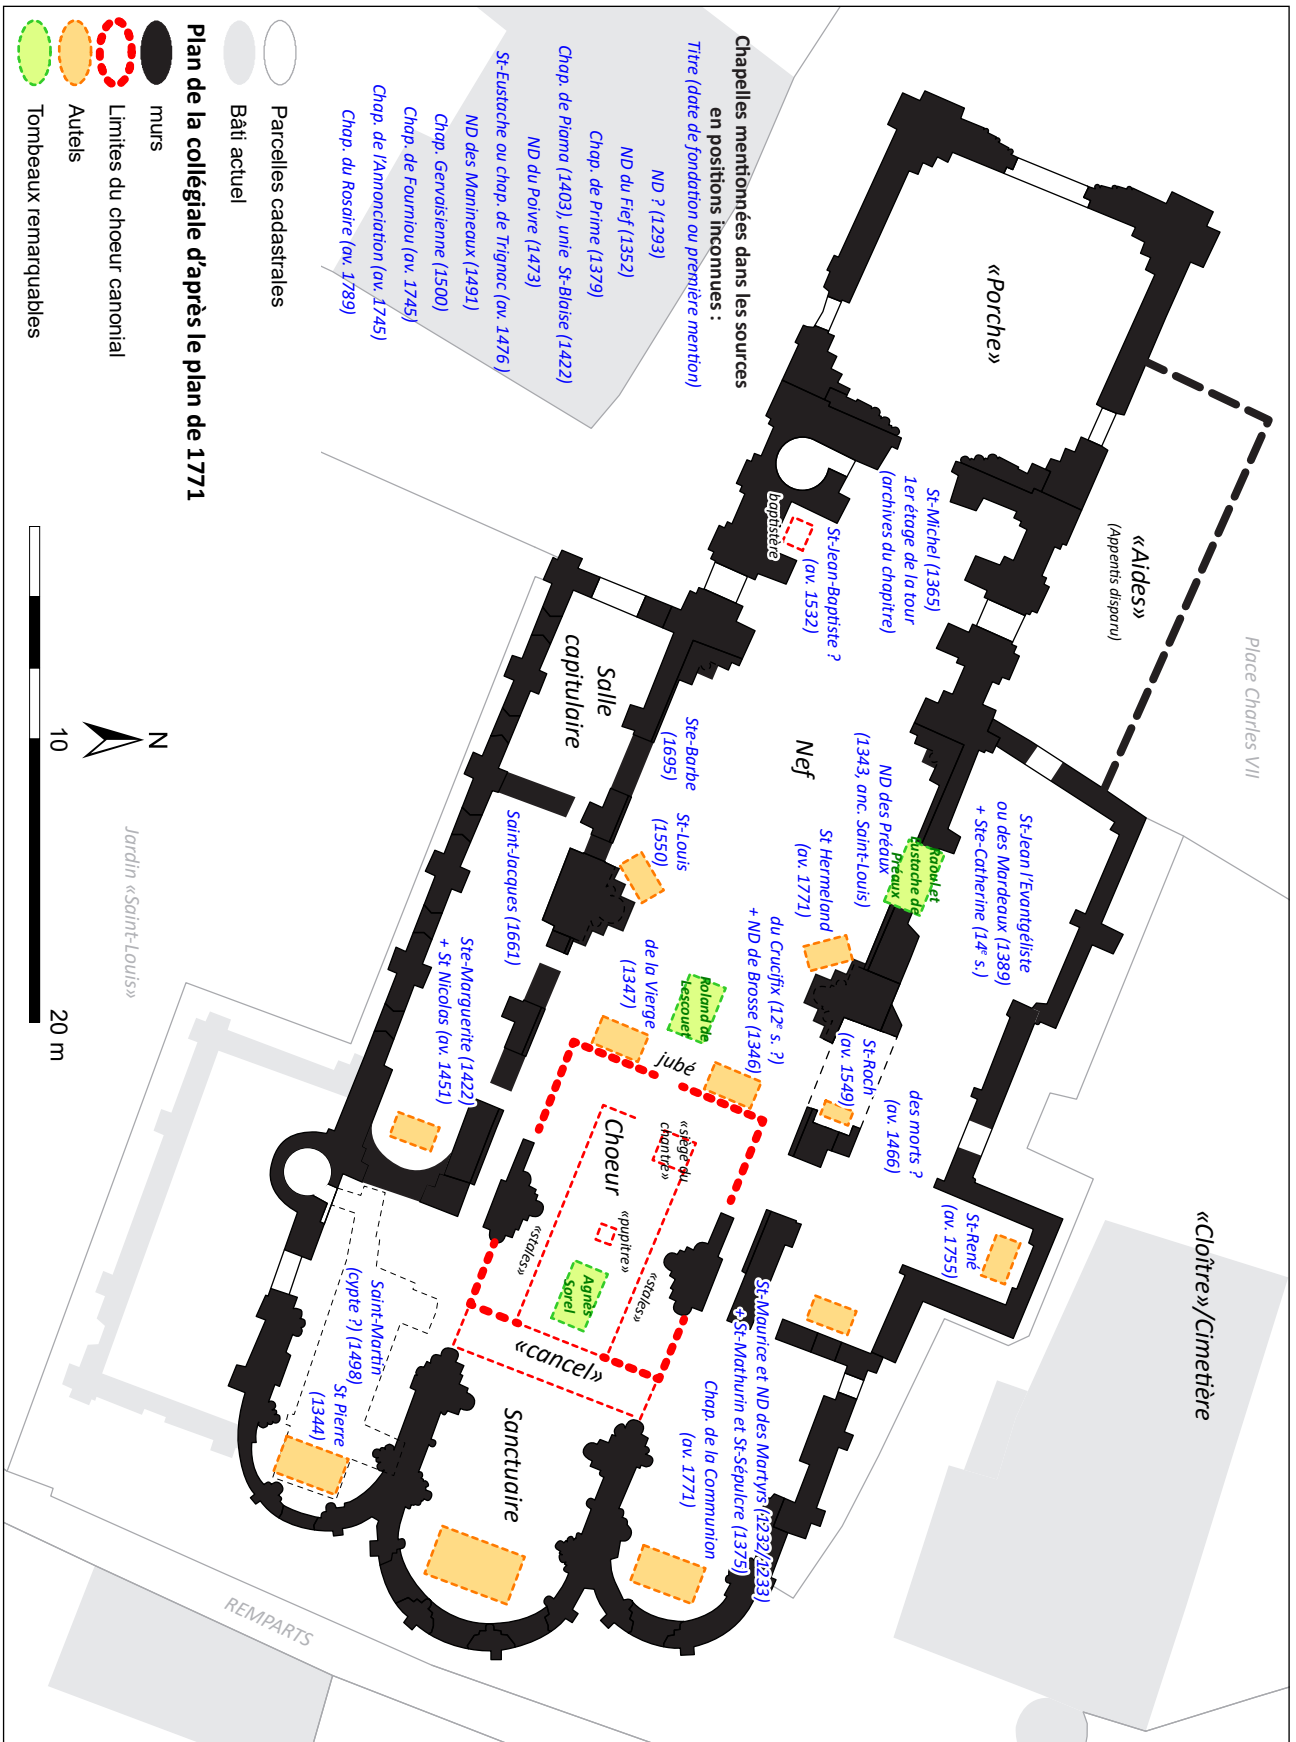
Plan de la collégiale Notre-Dame de Loches d'après le plan de 1771, avec localisation des chapelles mentionnées dans les sources documentaires
